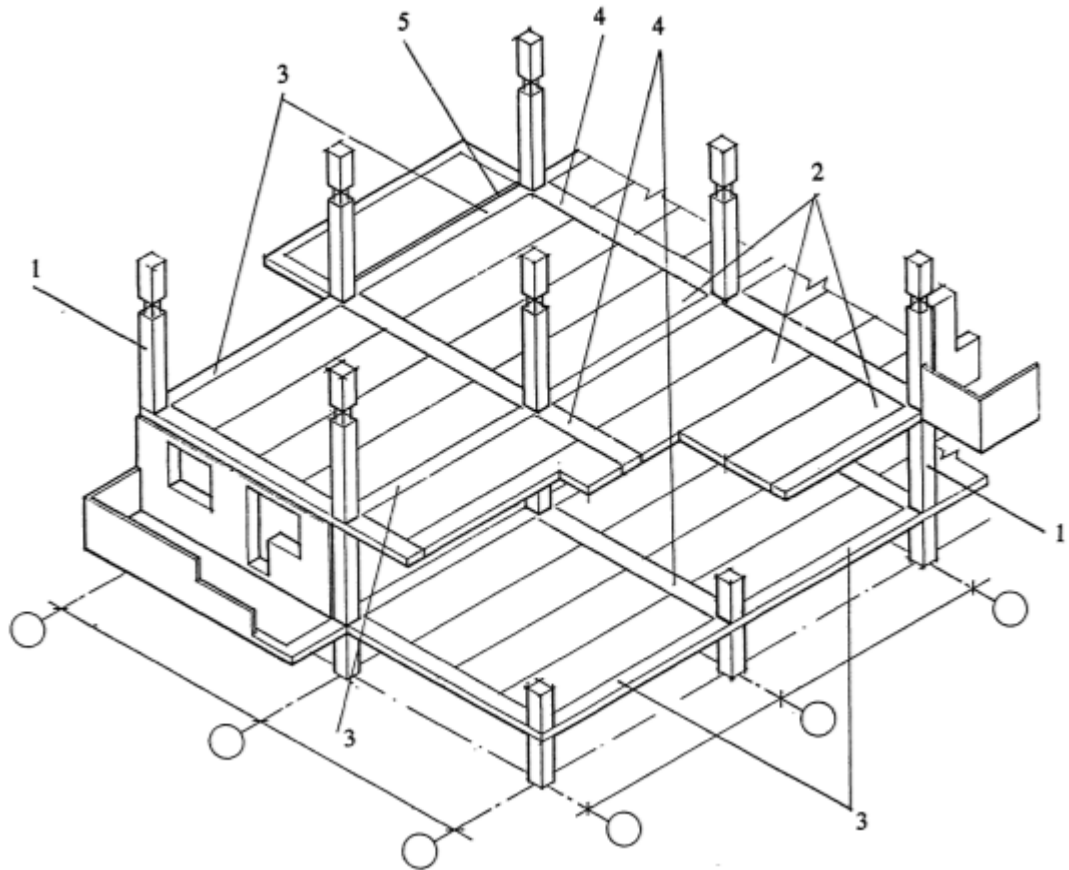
Система СМК з використанням пустотних плит. 1- збірні з/б колони; 2- пустотні плити перекриття; 3- несучі монолітні з/б ригелі; 4- в'язеві монолітні з/б ригелі; 5- теплоізоляційна прокладка.
